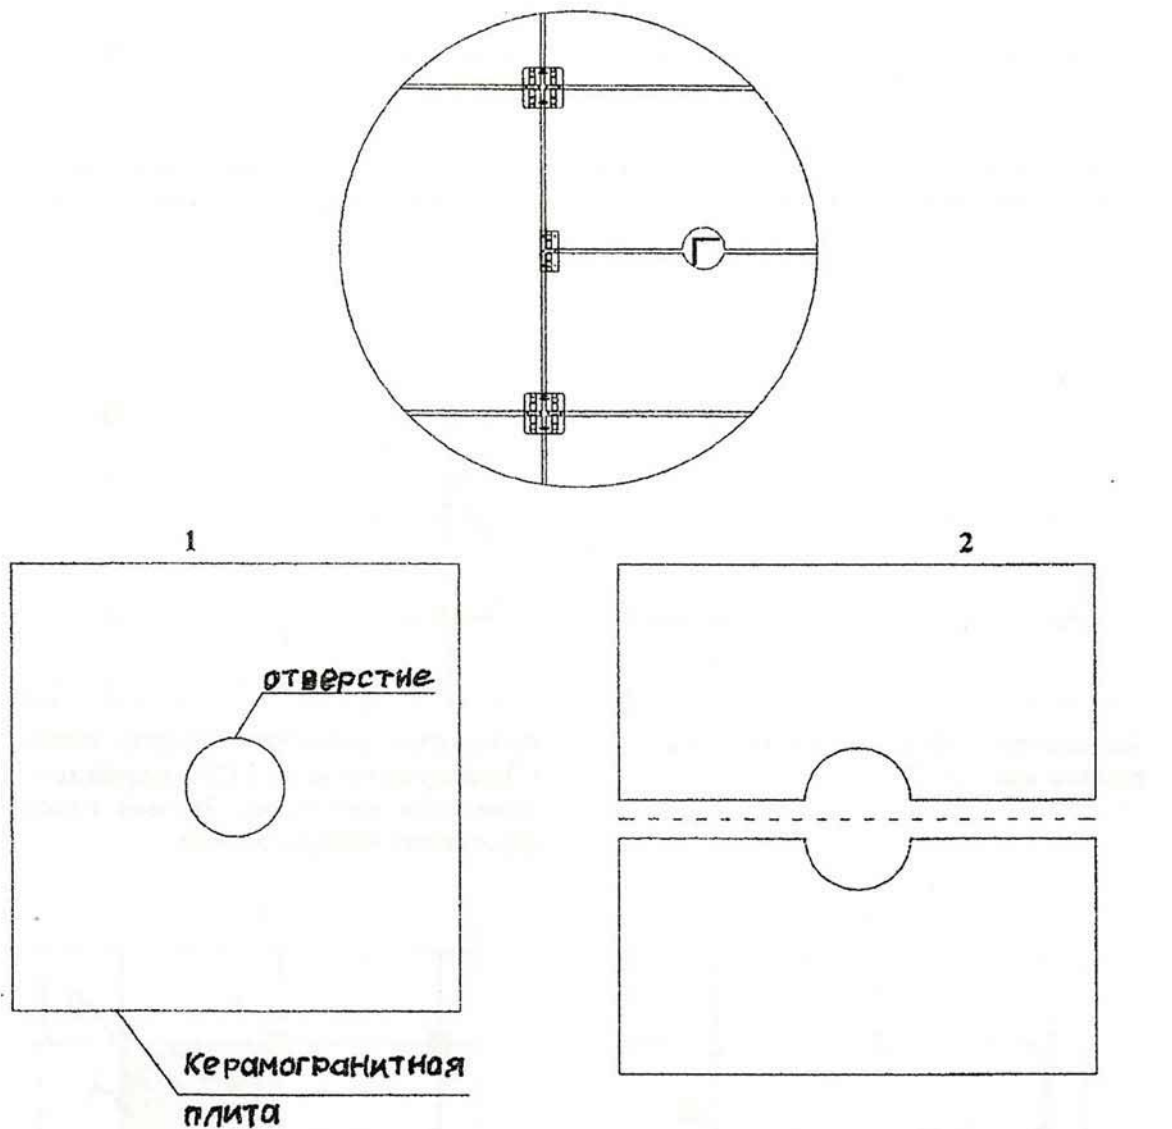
Закрепление наружной рекламы к направляющей на фасаде:
